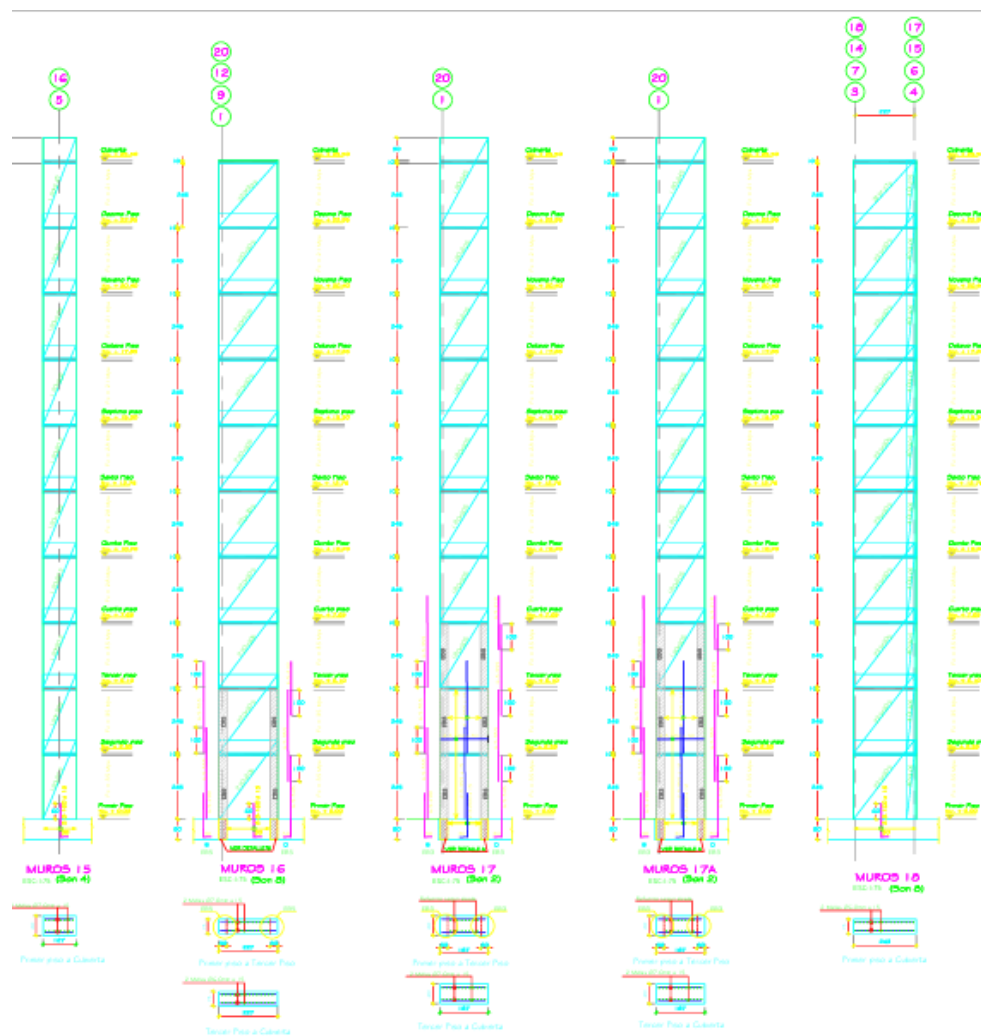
Alzadas de muros 15-16-17-17A-18
